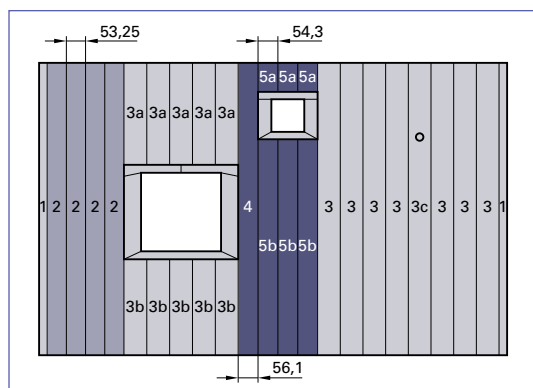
Bahnaufteilung mit Einbindung der Dachdurchbrüche einschließlich der Verlegenummern, mit AutoCAD erstellt
